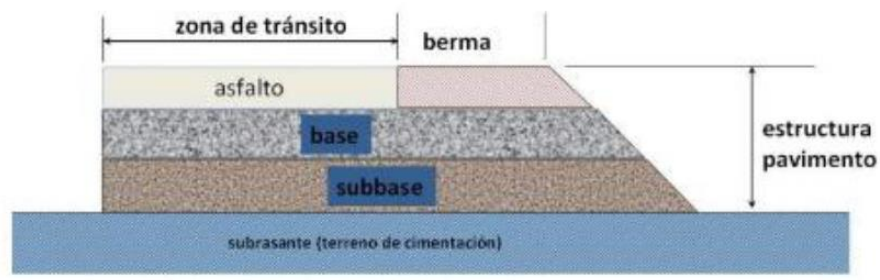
Sección transversal del pavimento flexible, por Baque-Solis, 2020, p. 208
